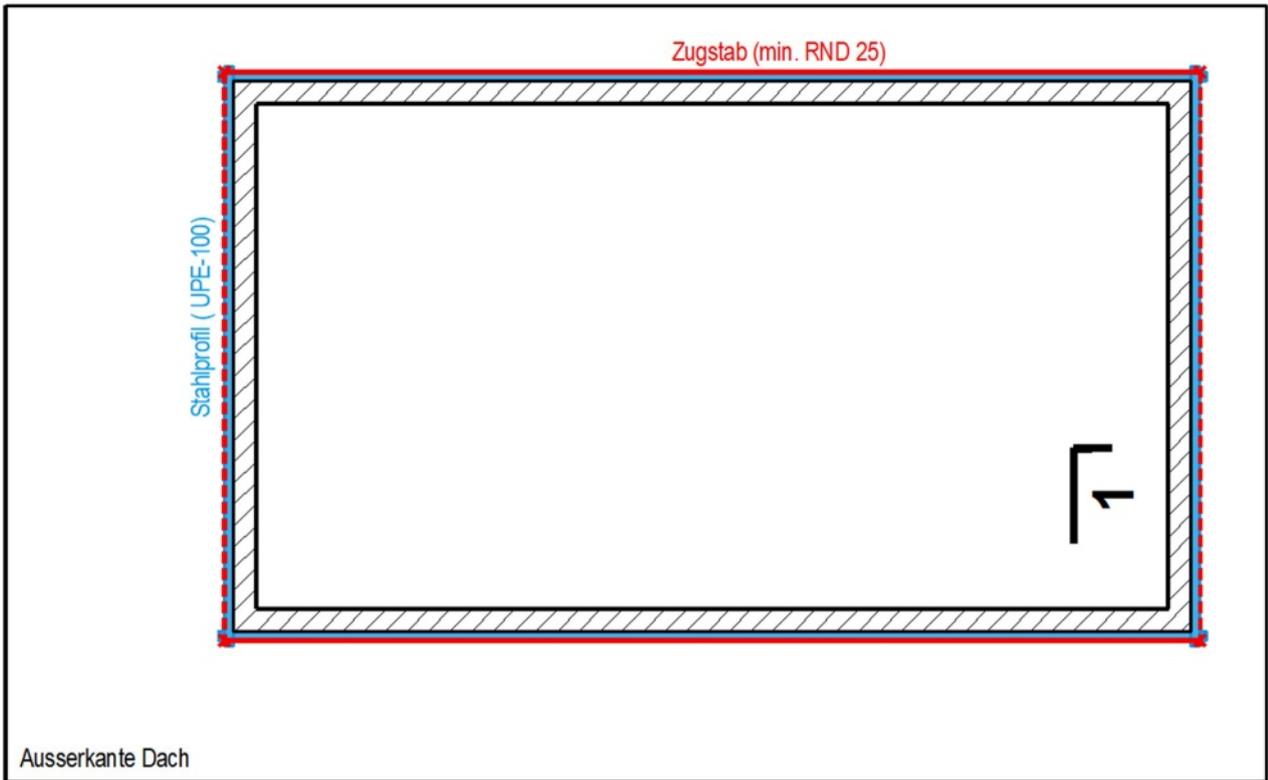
Grundriss mit aussenliegenden Zugstäben zur Stabilisierung des Mauerwerks
